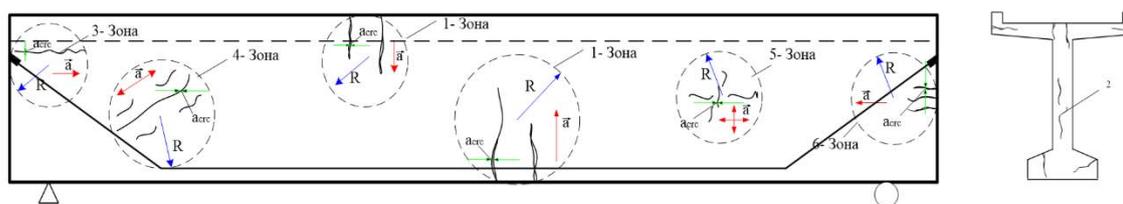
Схема характерных зон трещин предварительно-напряженных балок железобетонных мостов по данным обследований
